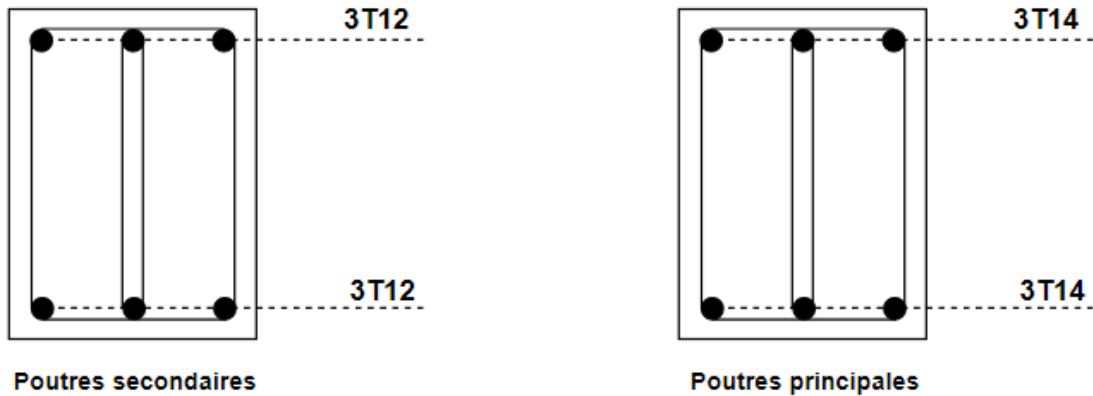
Dessin de ferrailage des sections des poutres principales et secondaires.
